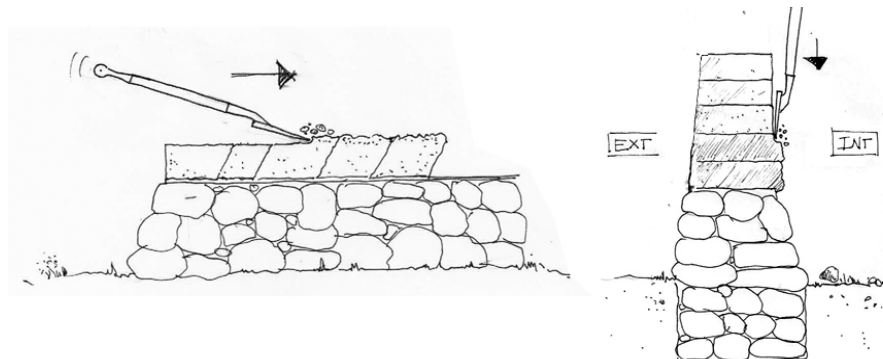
Emparejado de planos horizontales y verticales. Ilustración del proyecto *enTerrón*, 2013.
